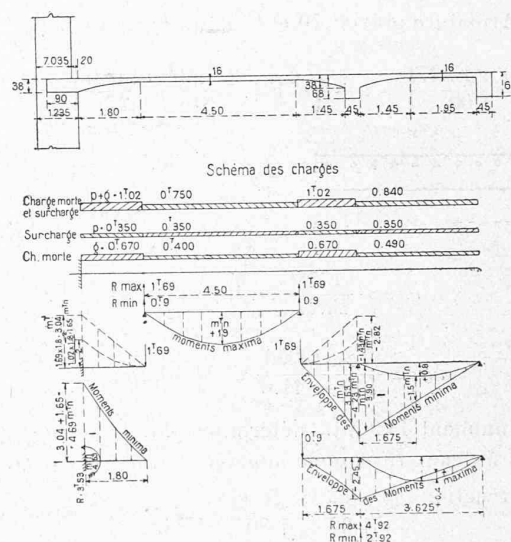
Poutraison sur rez-de-chaussée. — Coupe C-D.
